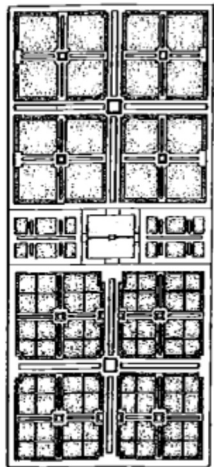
planta do jardim de Shalamar Bagh, em Lahore.
